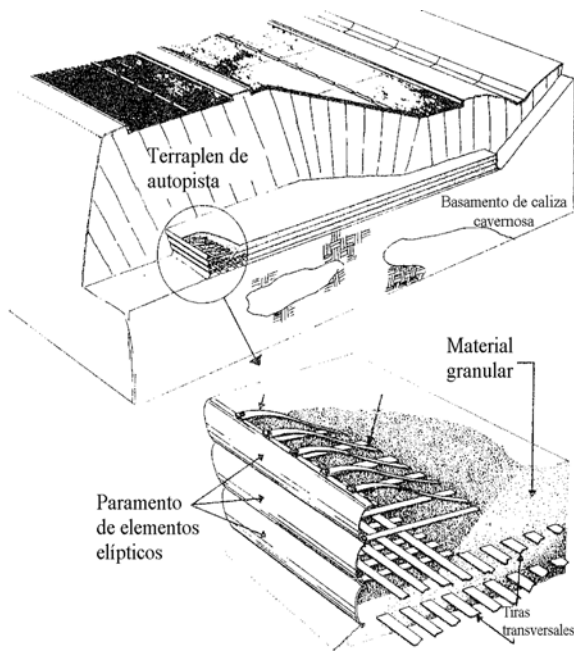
Uso de tierra armada como losa de fundación (Steiner, 1975)
